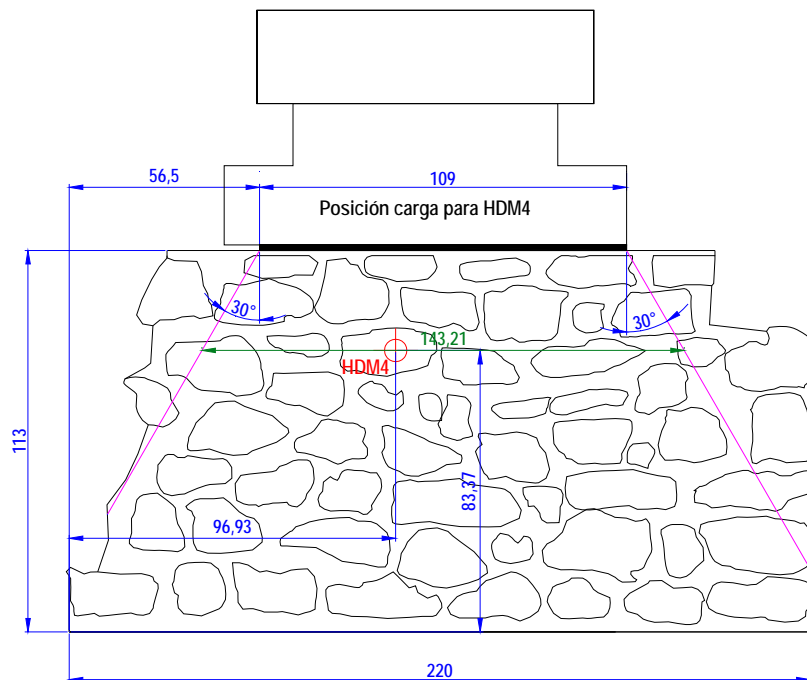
Alzado del muro de mampostería con la localización del HDM4. El espesor del muro son 31 cm. Las cotas referidas son cm.
